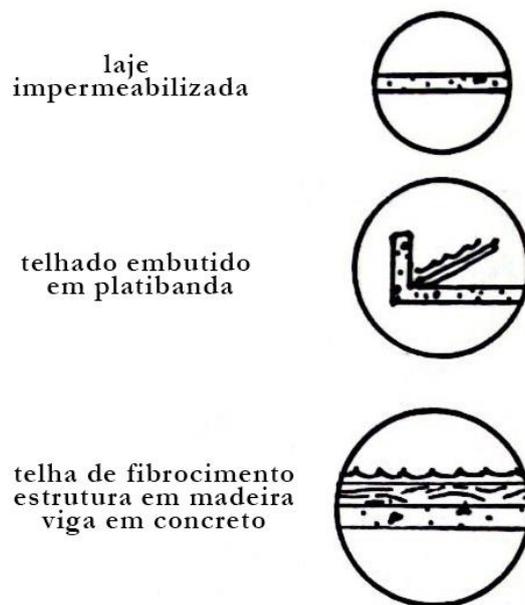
Esquema de soluções para coberturas observada nos projetos de Schwab: os dois primeiros com linha única horizontal – laje impermeabilizada e platibanda; e a terceira com as horizontais múltiplas em fachada, combinando telha, estrutura do telhado e vigas de cobertura.
